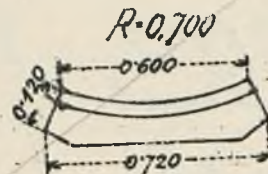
, 34 przedstawiają kształtki wykonane wierzchołkowe z ubitą, betonową.
